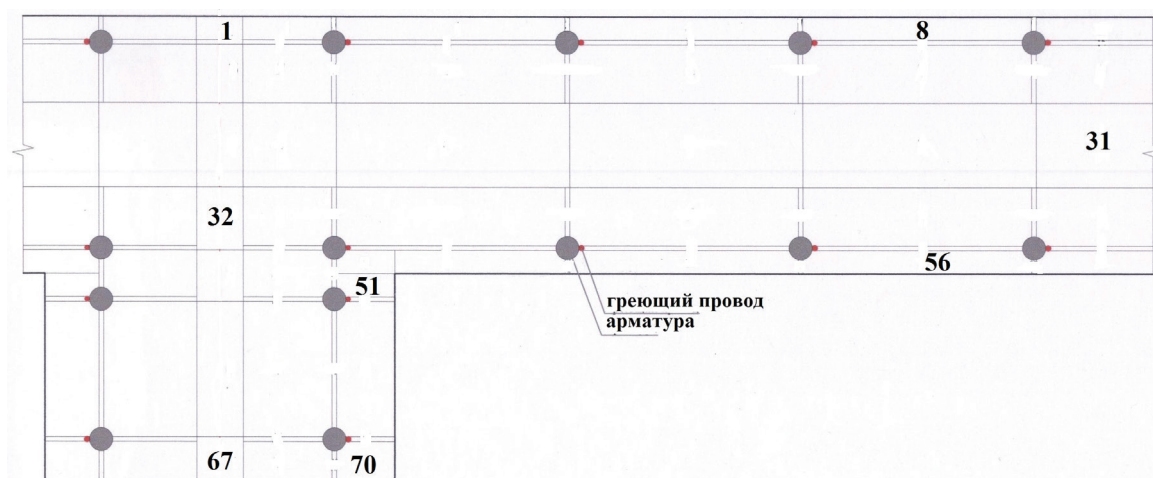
Расчётная схема плиты перекрытия с ригелем при бетонировании с электропрогревом с шагом проводов 200 мм
